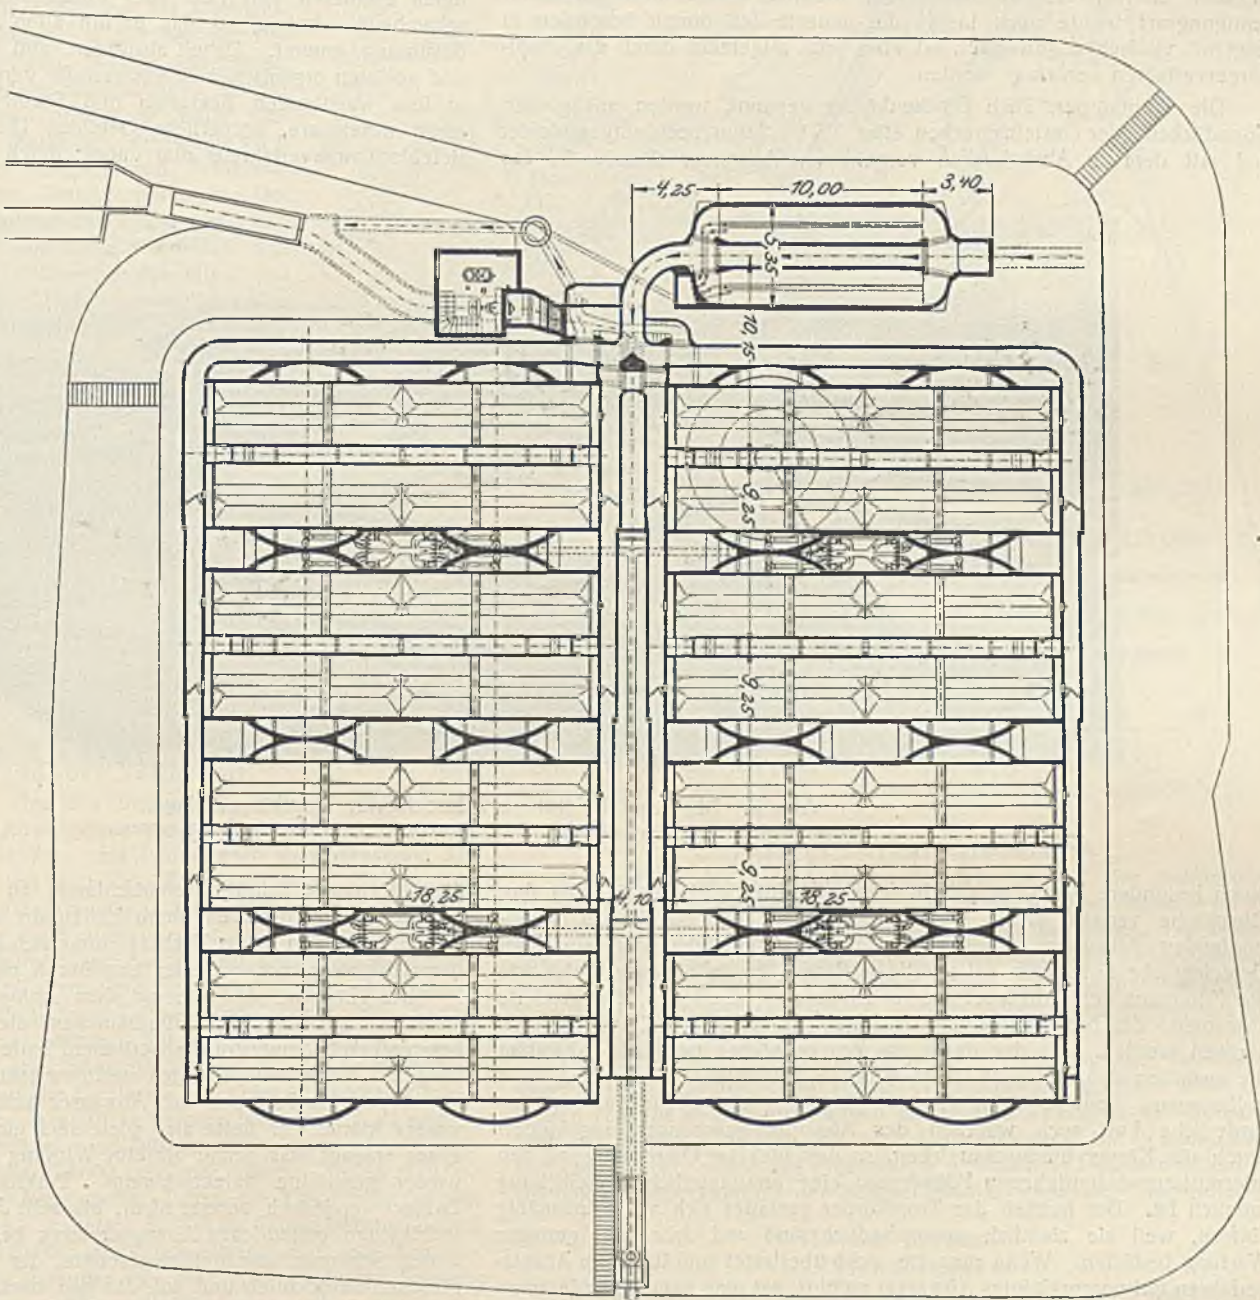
Emscherbrunnenanlage als Vorreinigung für das Rieselfeld Berlin-Wansdorf. Grundriß.
